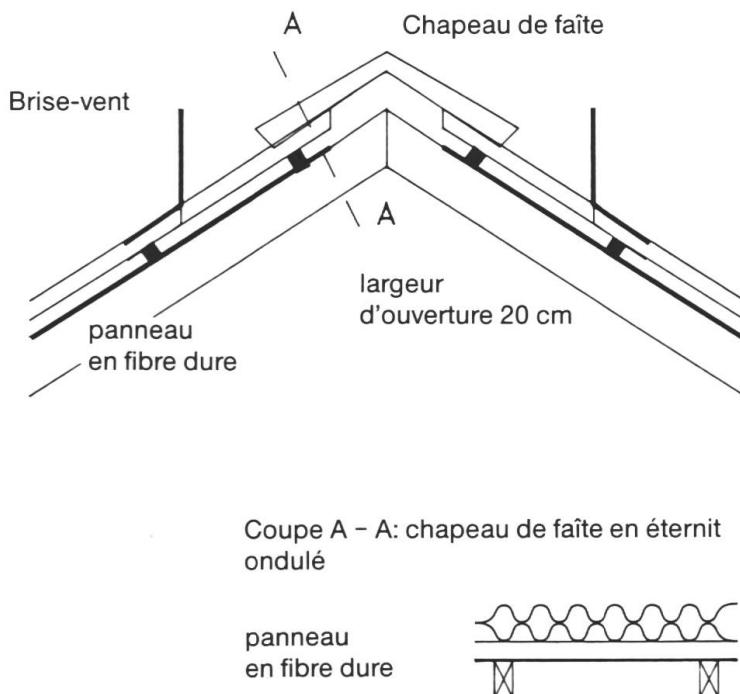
Conception du faîte d'un toit ventilé pour plafond perforé avec chapeau de faîte, brise-vent et ventilation de sous-toiture entre des panneaux en fibre dure et de l'éternit ondulé.
